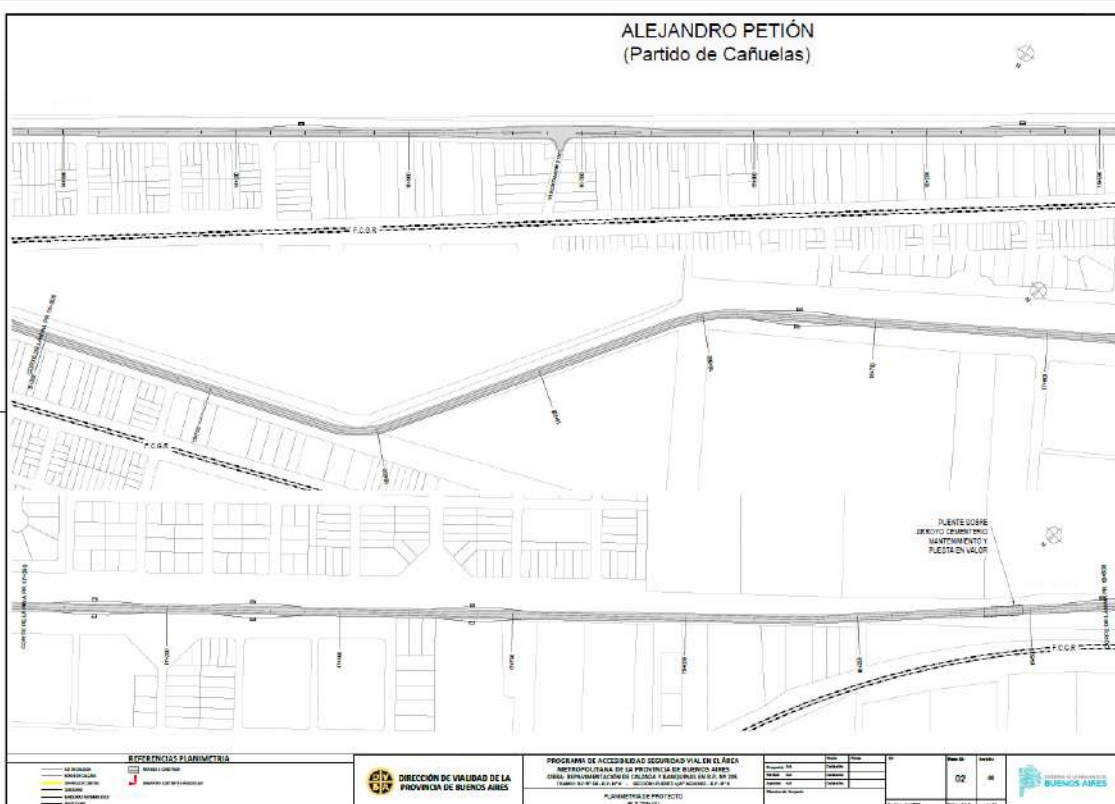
Planimetría de Proyecto RPN°205 (4)
